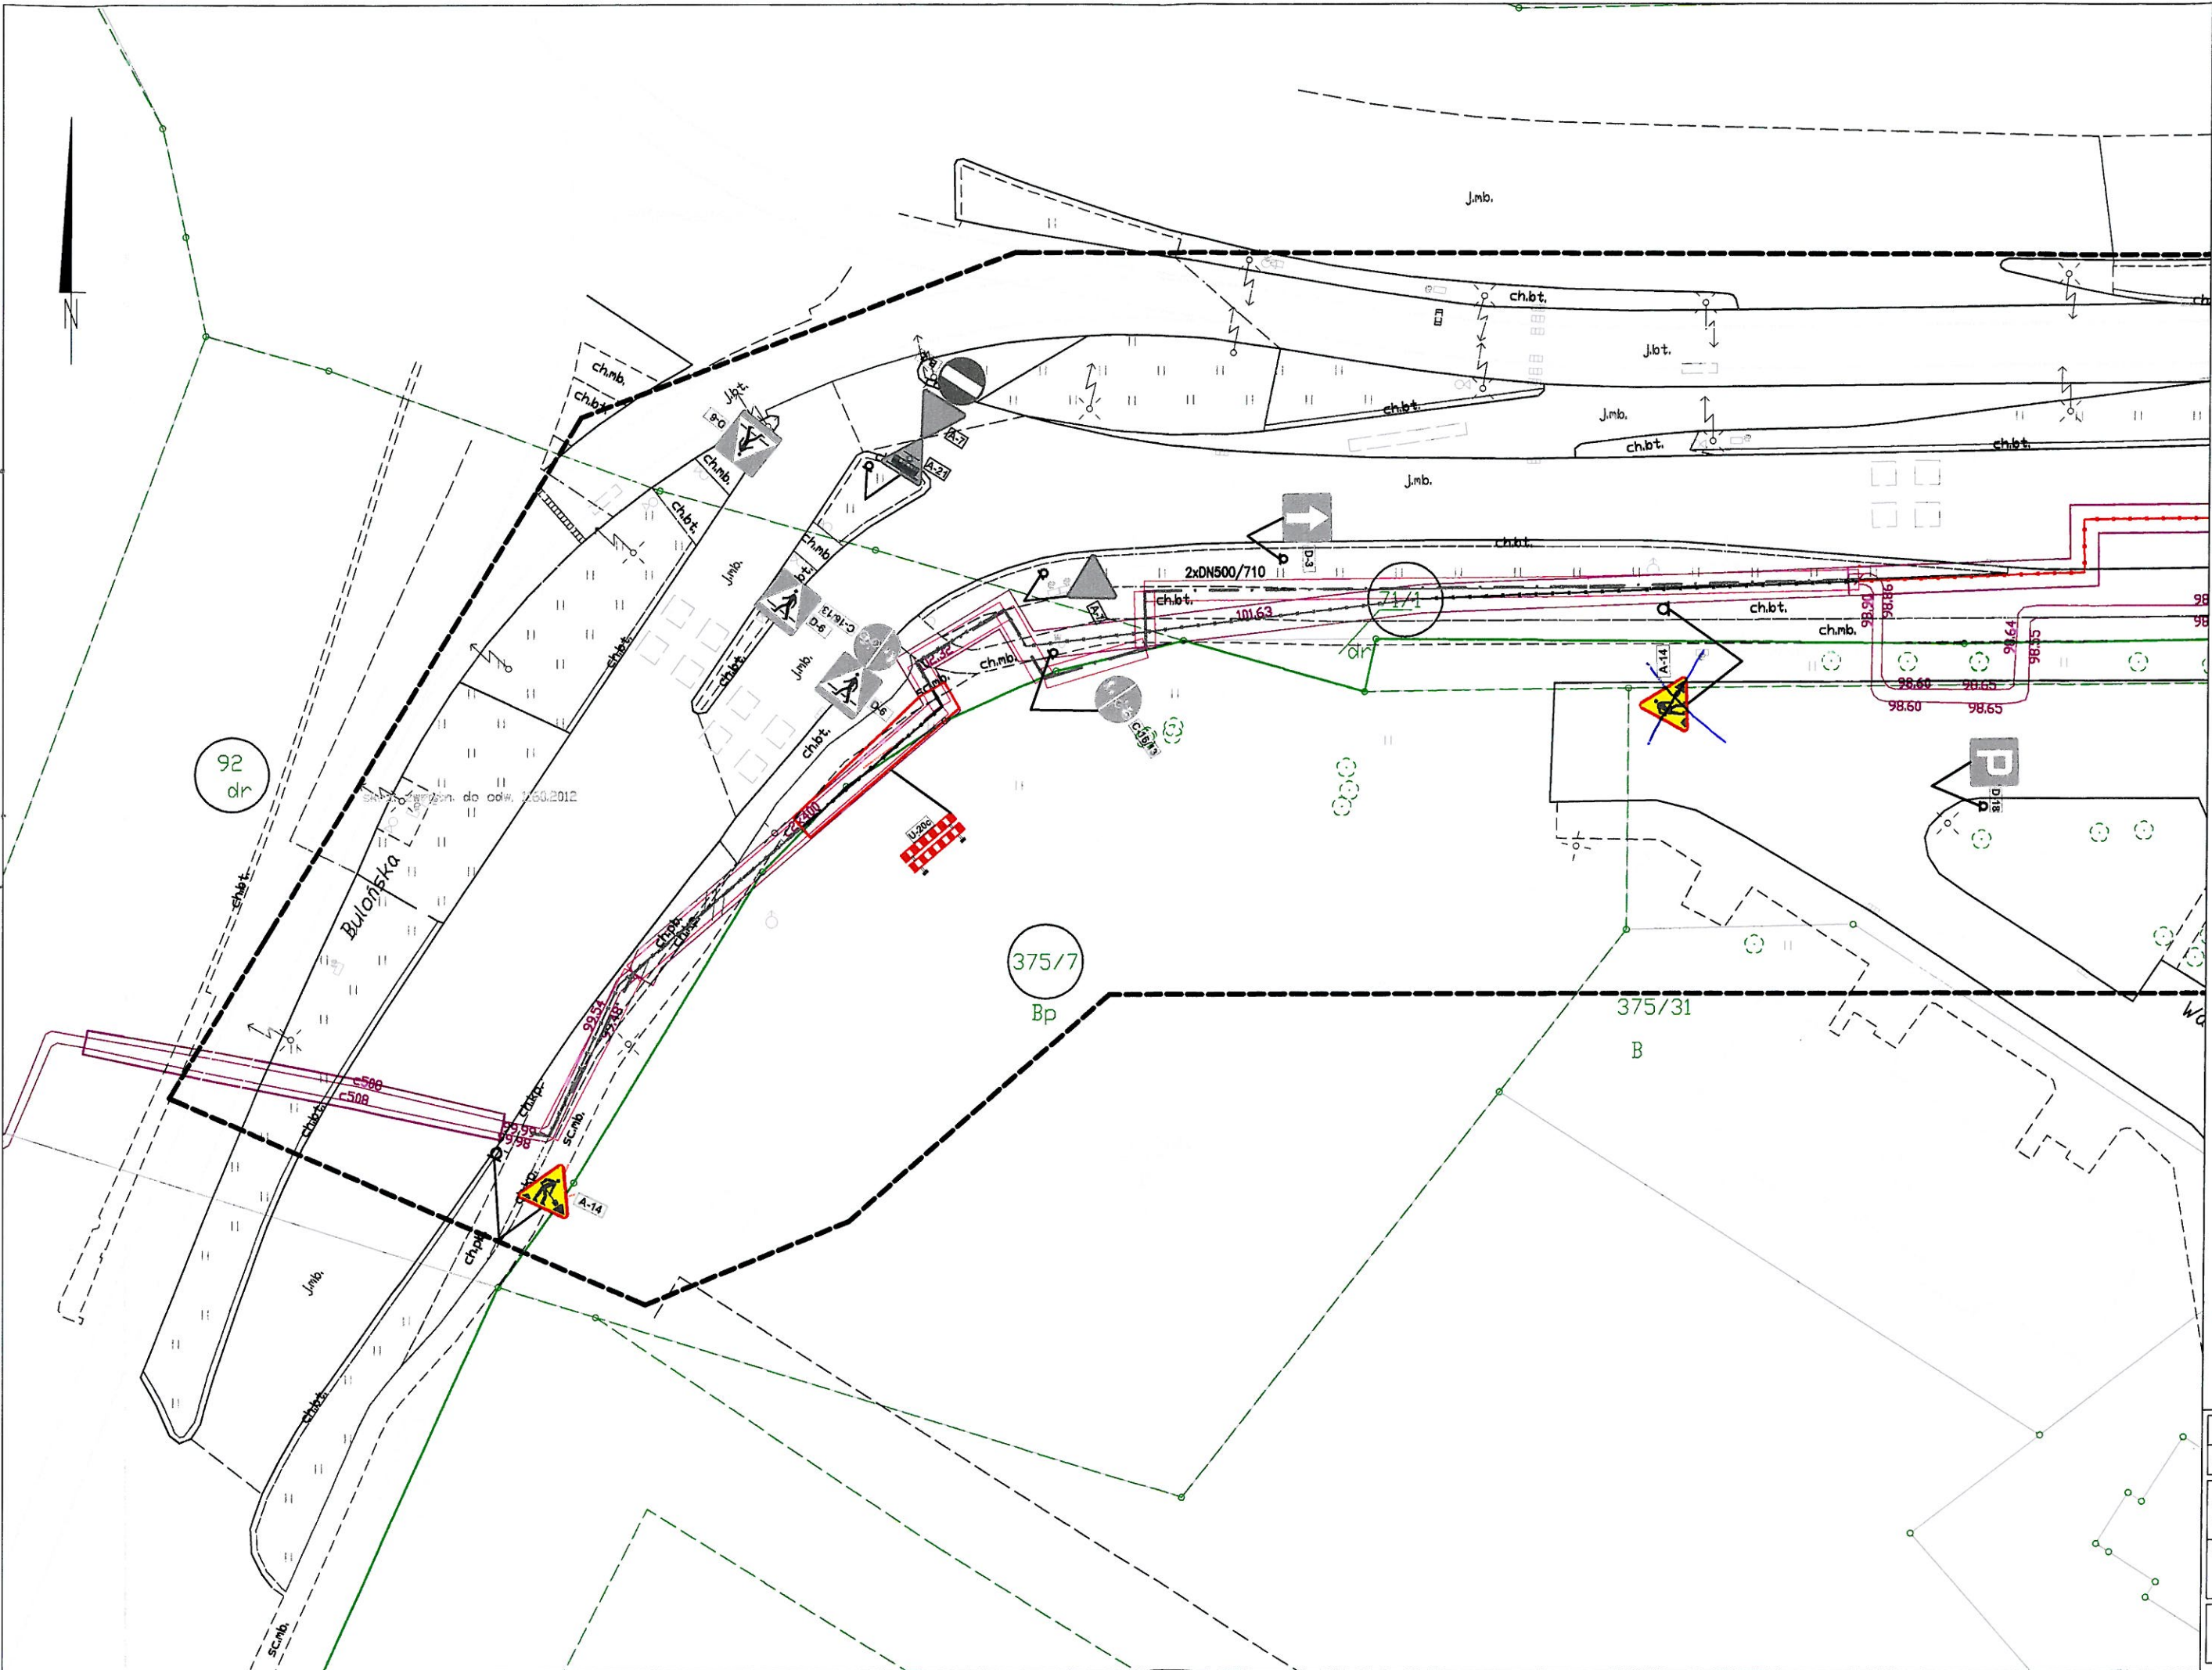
Ark. 6/7 – plan sytuacyjny: ETAP VI
